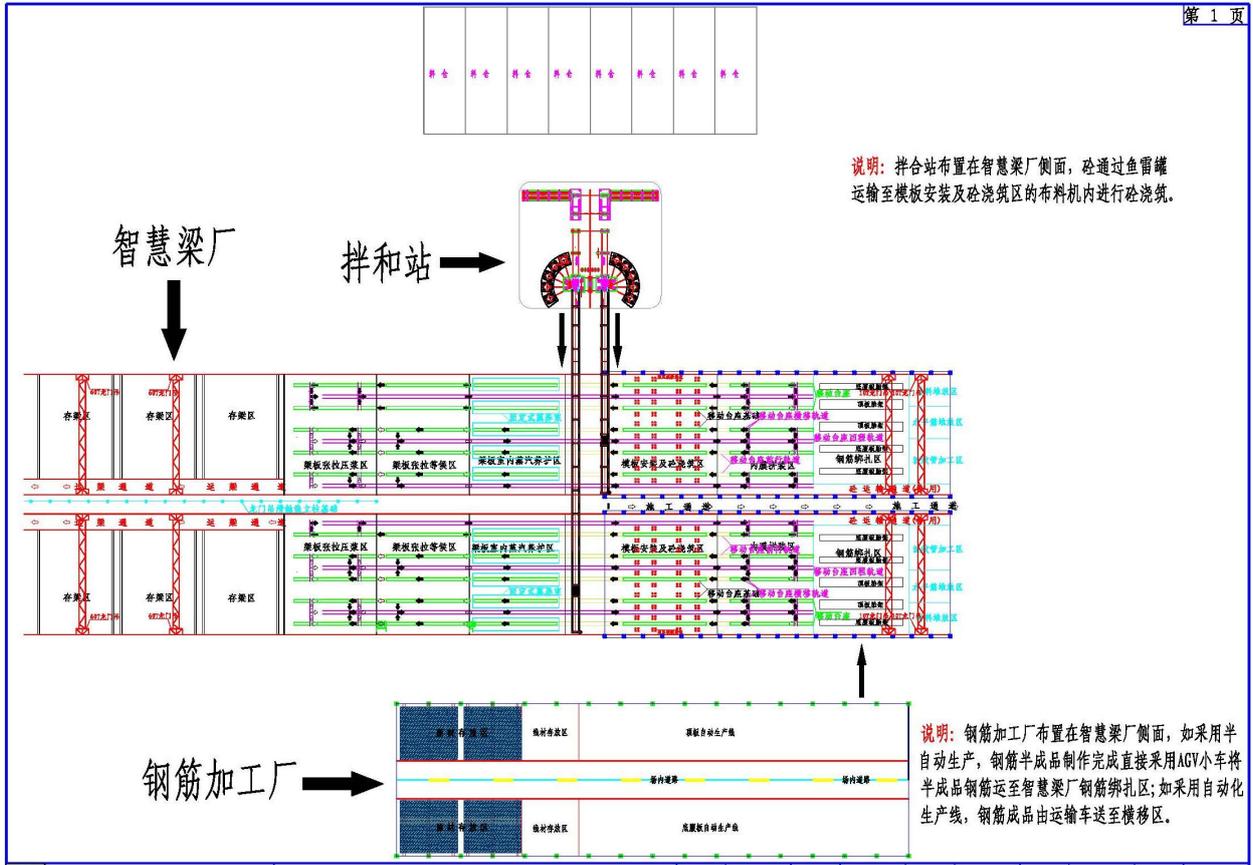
智慧梁厂、拌和站及钢筋厂三者布置示意图
